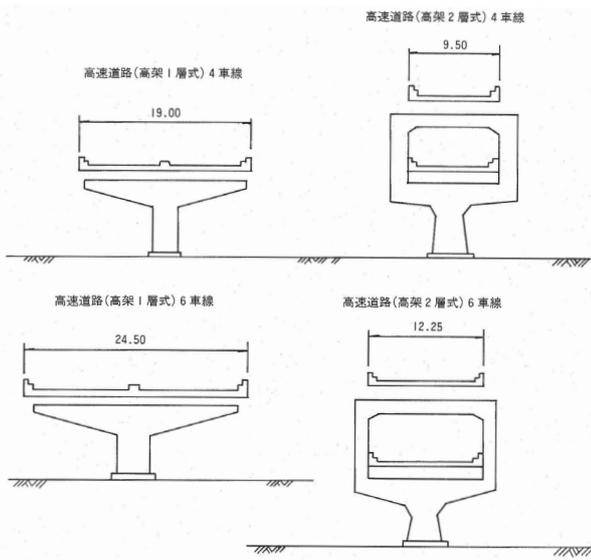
標準断面図 (昭和 45 年 9 月)
